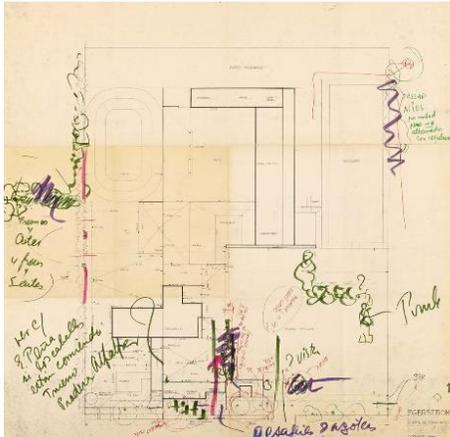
Planta de conjunto de Cuadra San Cristóbal, Los Clubes, Estado de México. Fuente: Fundación Barragán.
